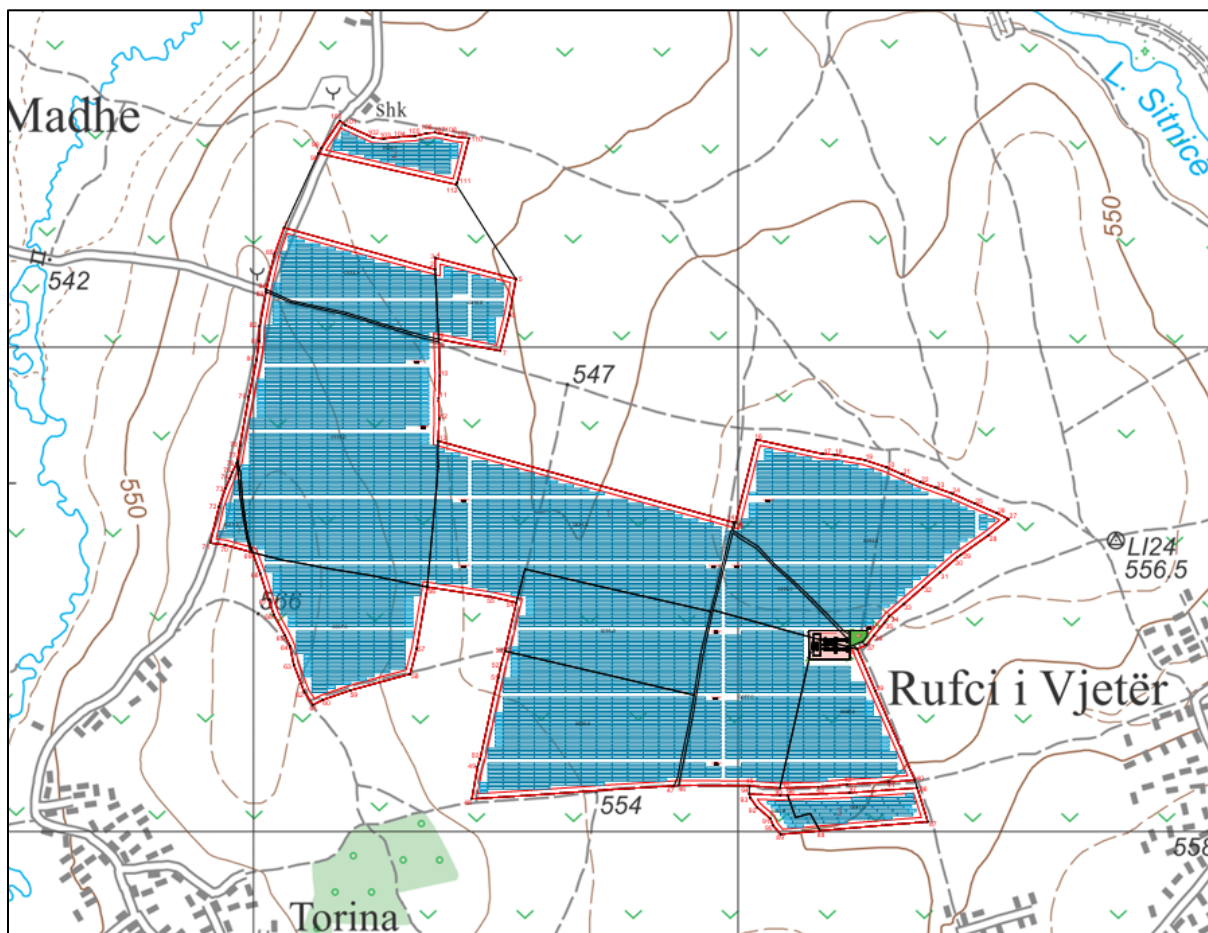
Plan situacioni i shtrirjes së paneleve solare.
